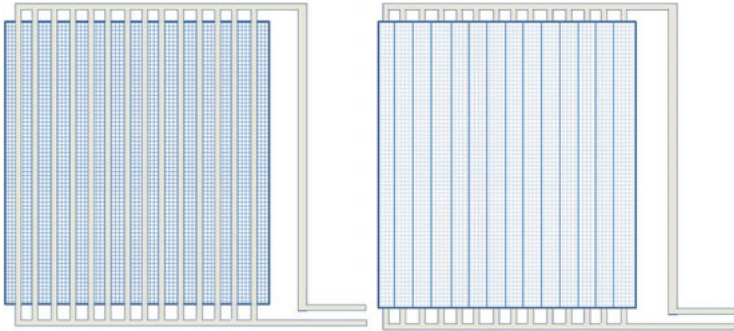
Thermisch aktive Wandsysteme; links: Typ 1, Gewebe mit integrierten Schläuchen und den Anschlussrohren, rechts: Typ 2, beschichtetes Gewebe mit ultraschallgeschweißten Kanälen und den Anschlussrohren
